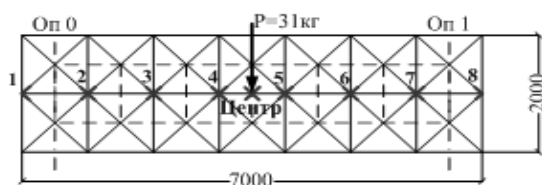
Схема для динамических испытаний на 1-м и 2-м этапе
